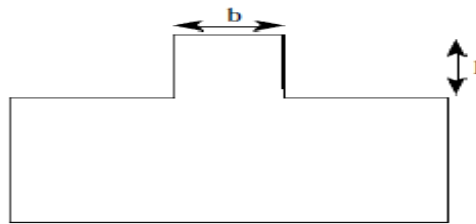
Regularidad de simetría y área saliente de planta.⁽²⁷⁾
